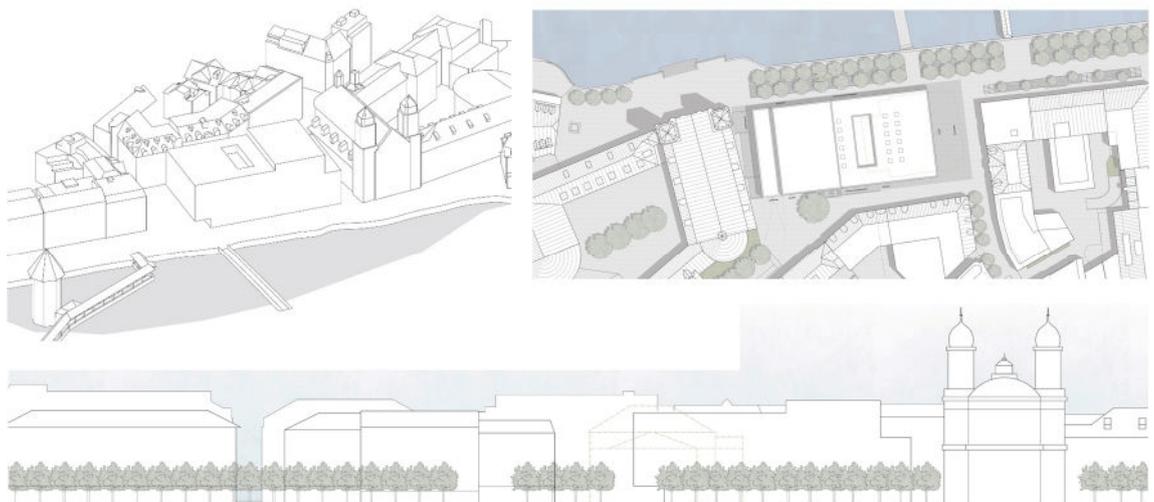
Axonometrie, Lageplan und Ansicht Reuss-Seite, Beitrag Testplanung f. Neubau, Bosshard & Luchsinger Arch.
